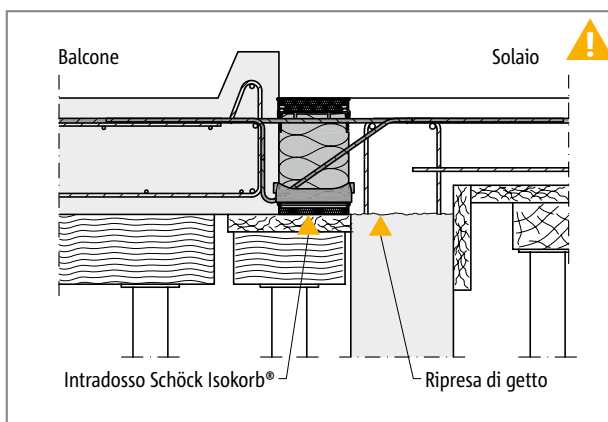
Schöck Isokorb® XT tipo KL: balcone finito dotato di solaio con salto di quota su parete preassemblata in calcestruzzo armato.
